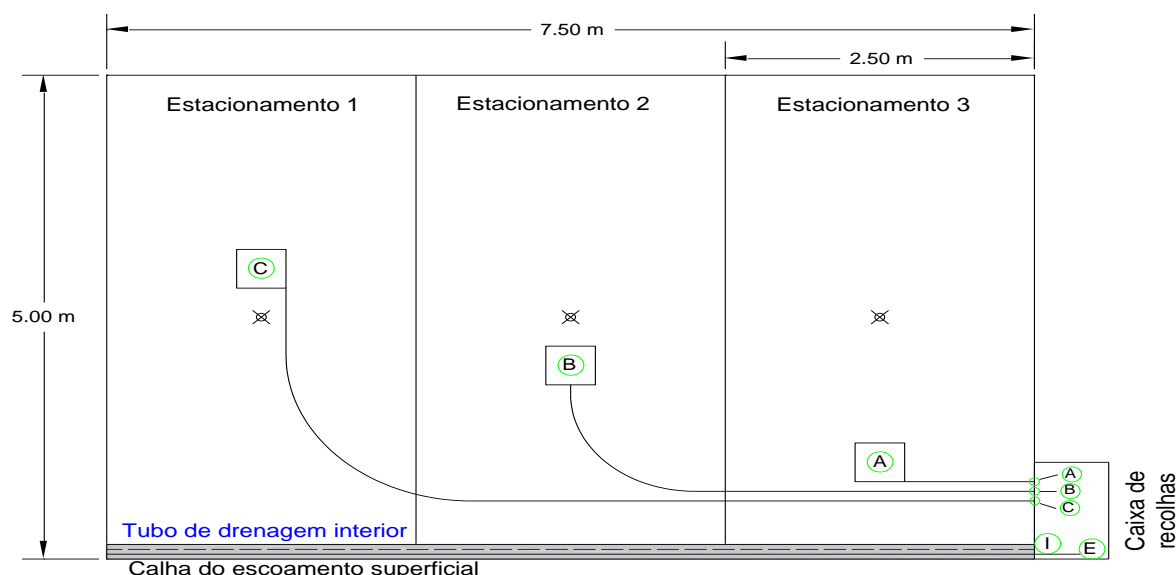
Área em planta e pontos de recolha no TE2: I – Água recolhida no tubo de infiltração no fundo do pavimento; E – Água da calha que recolhe o que esco superficialmente do pavimento; A, B e C – Água recolhida pelas caixas A, B e C situadas imediatamente abaixo das camadas betuminosas
